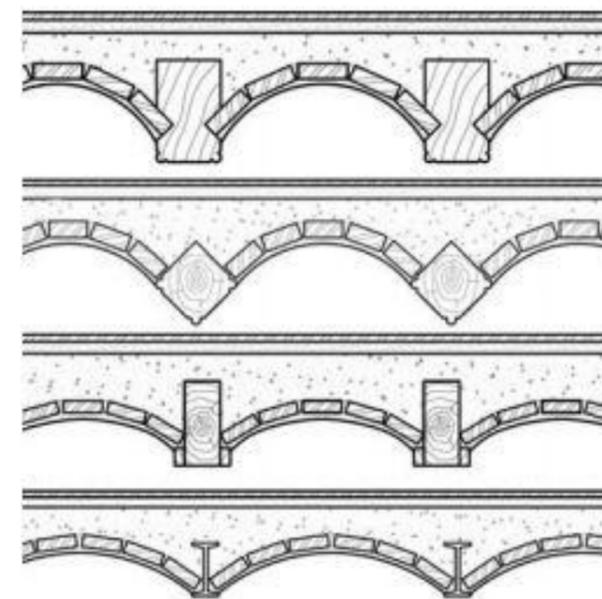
Tipos de vigas en forjados de revoltón de rasilla.
